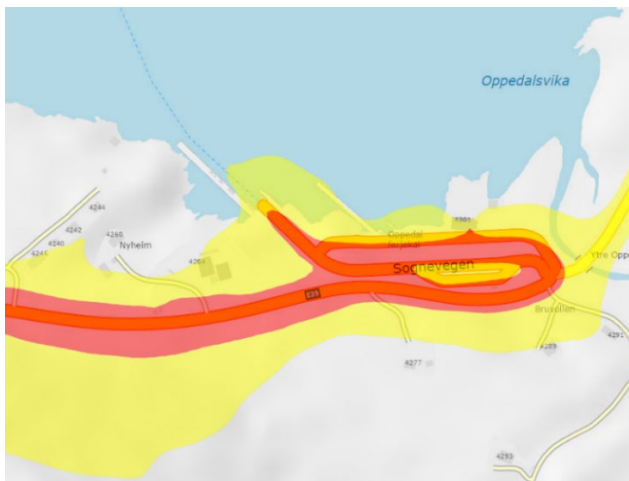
Planlagt skisse arealbruk eigedom 118/32 og 118/36
